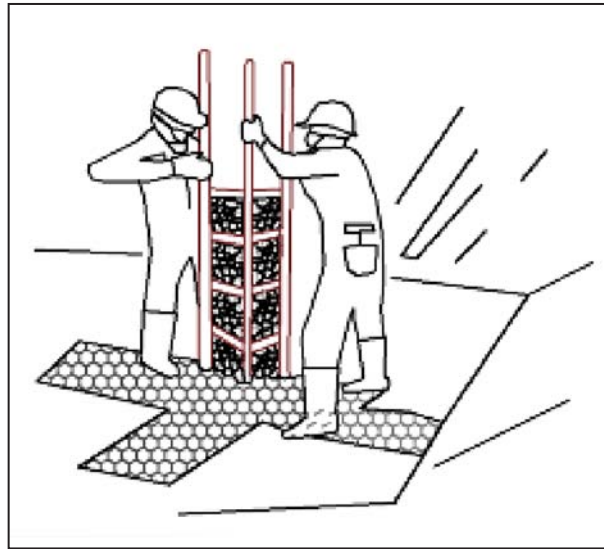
Instalación de chimeneas para drenaje de gases.
